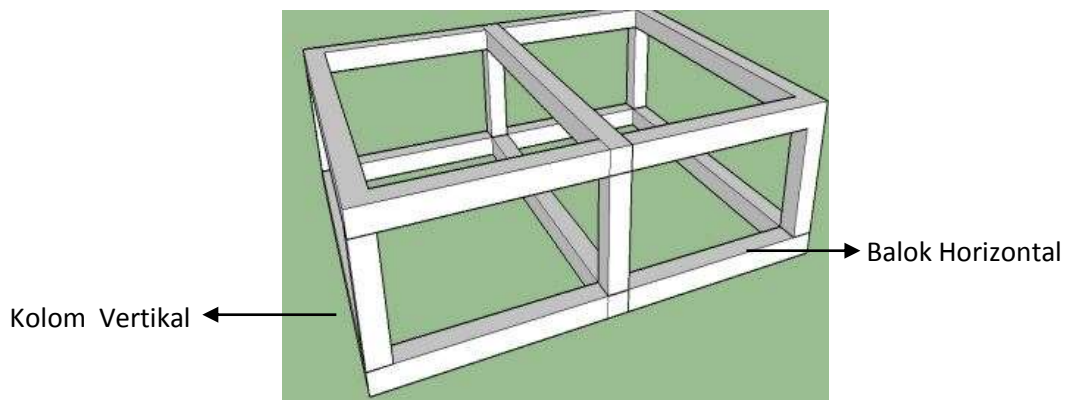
16 Konsep Sub Struktur Bangunan Lantai II
